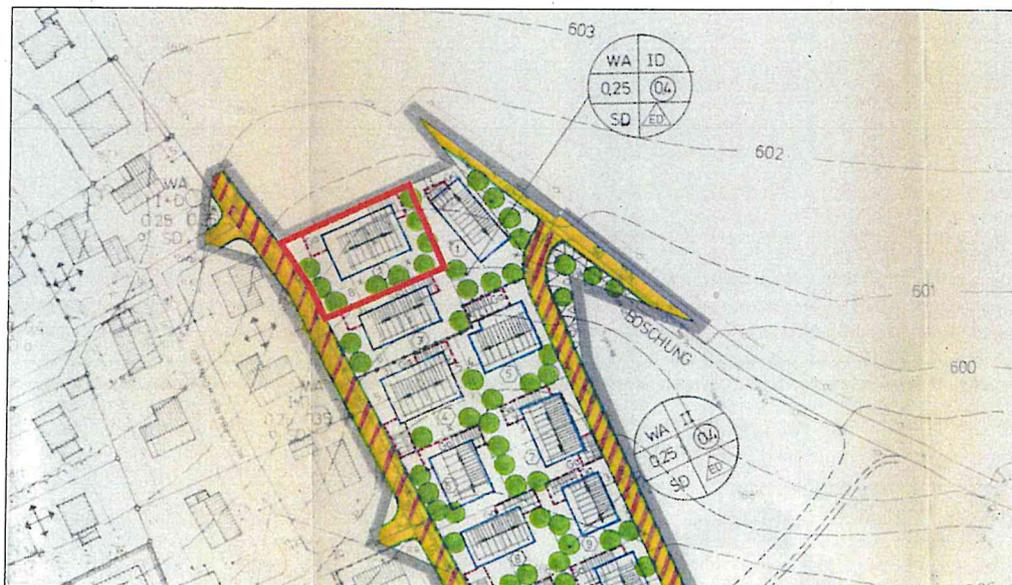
Auszug rechtsverbindlicher BP „Geltendorf - Schulstraße III“ mit Änderungsbereich
